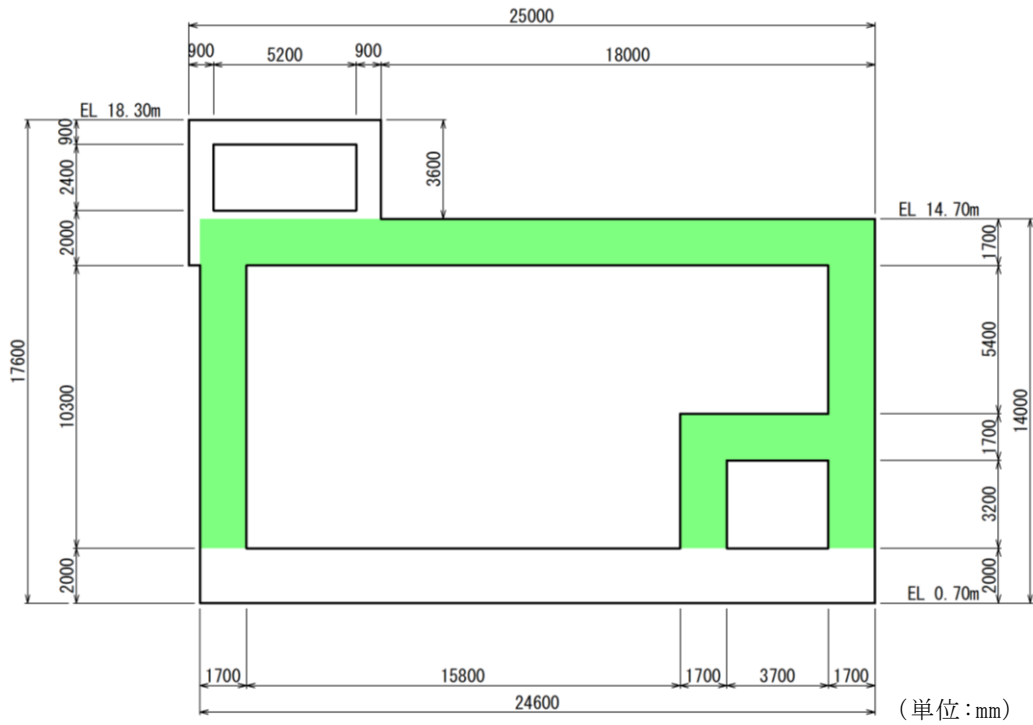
第1 ベントフィルタ格納槽 断面図 (A-A 断面位置)
